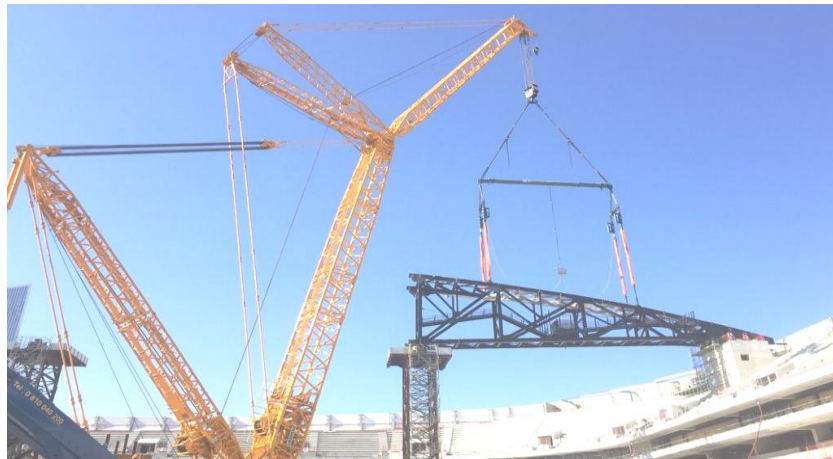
Photo d'une Grue de levage sur chantier [3]
